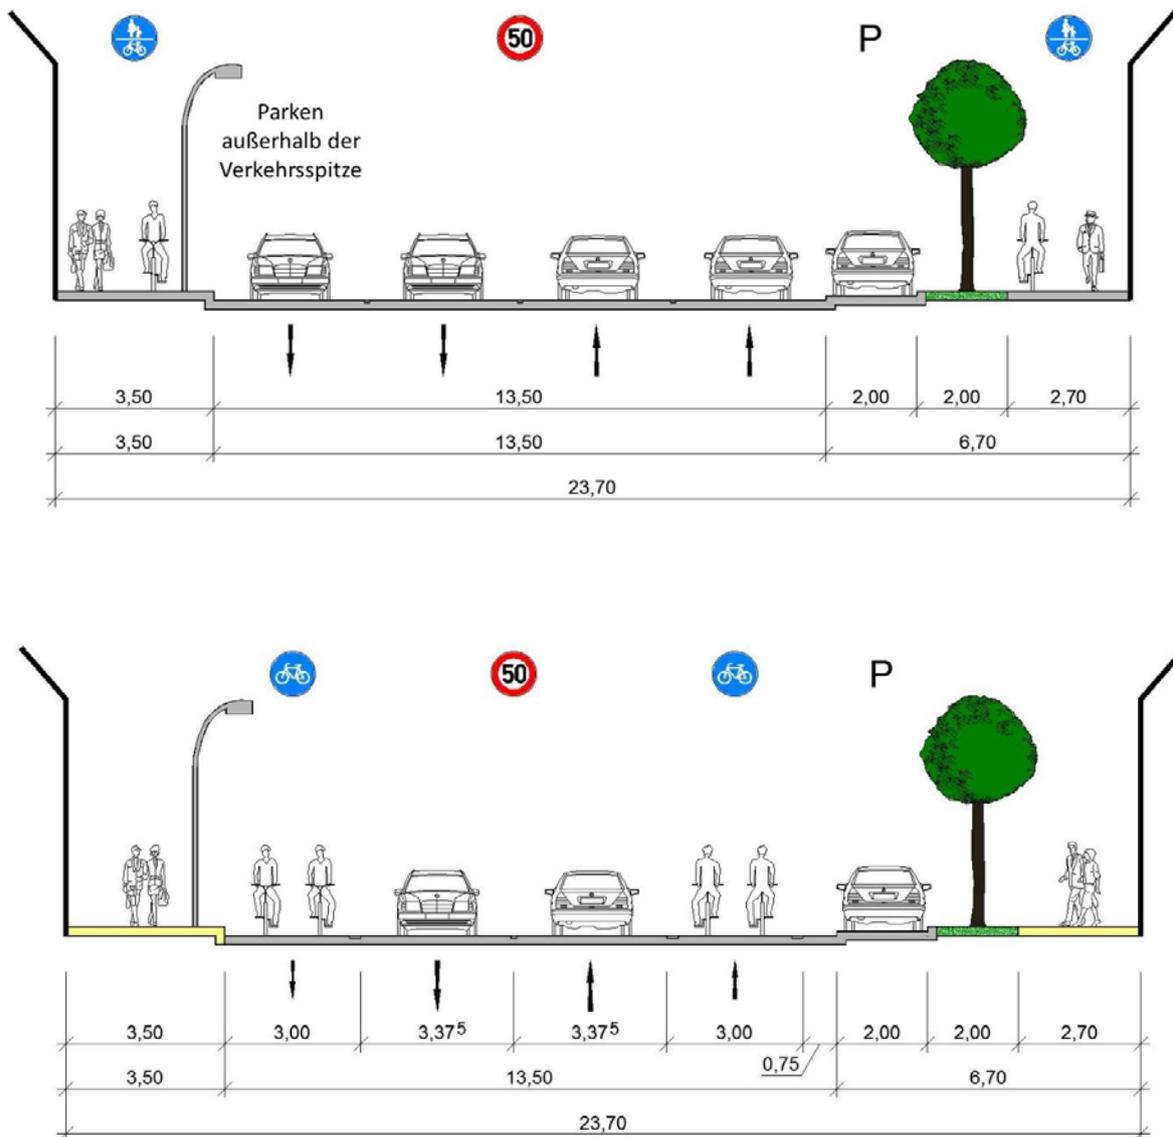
Gladbecker Str. (Stadtgrenze – Droste-Hülshof Straße) – Bestand (oben) und Planung (unten)
